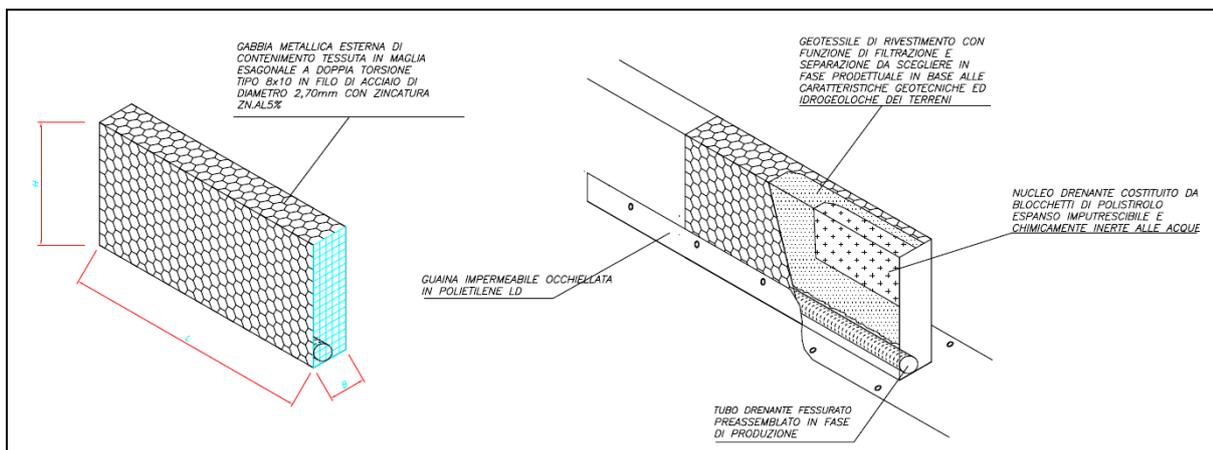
Sistema di drenaggio tipo Gabbiodren – posa in opera
